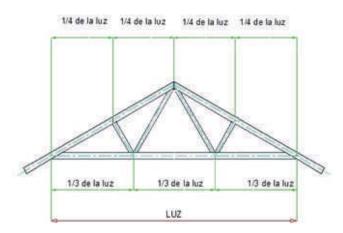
Cercha tipo Fink, con los elementos cortados y presentados para su fijación.
